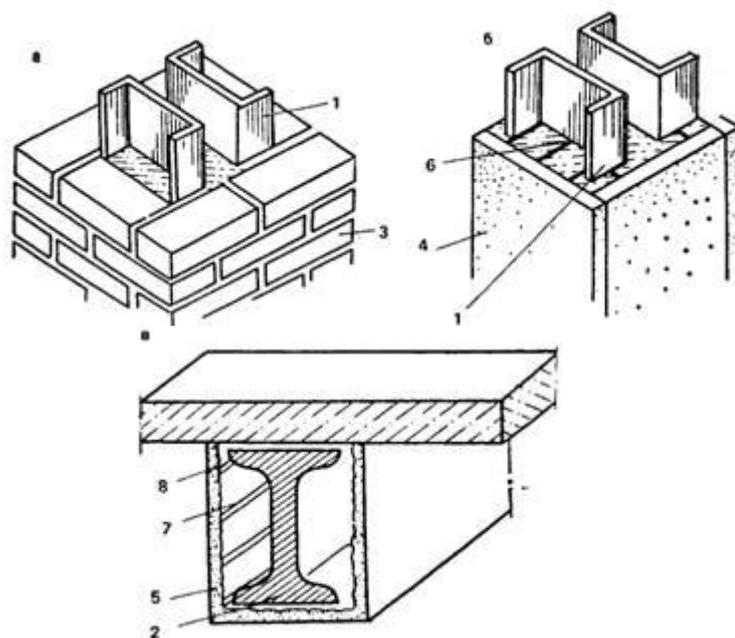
Защита металлических конструкций малотеплопроводными материалами. а – кирпичом; б – гипсовыми плитами; в – штукатуркой; 1 – стальная колонна; 2 – стальная балка; 3 – кирпич; 4 – гипсовая плита; 5 – штукатурка; 6 – анкер; 7 – арматурный каркас; 8 – объемная сетка
